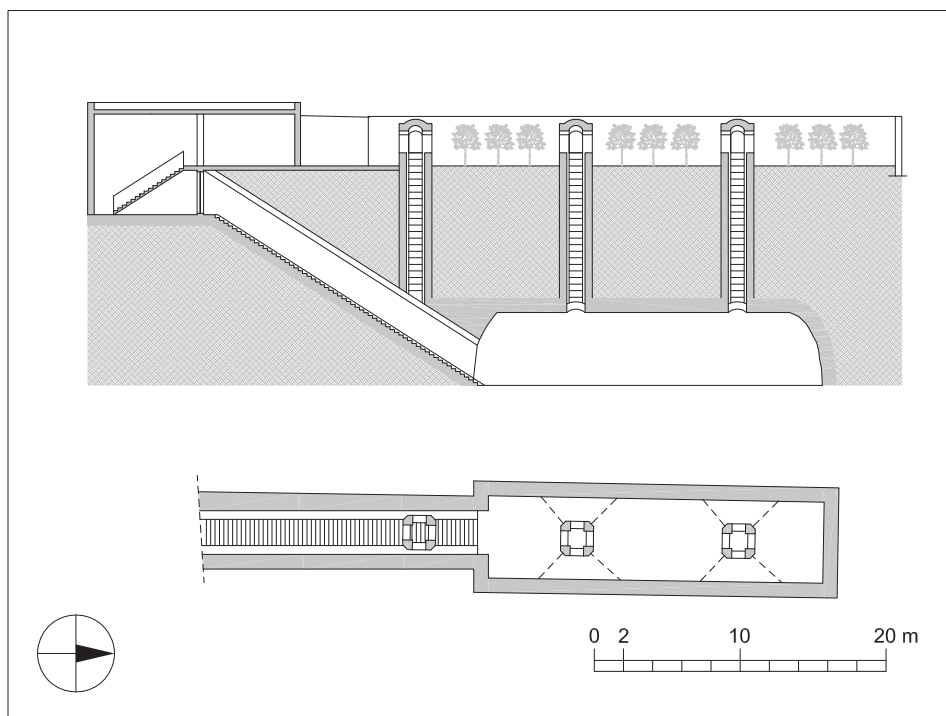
Comiziano, cantina C1. Pianta e sezione longitudinale.
